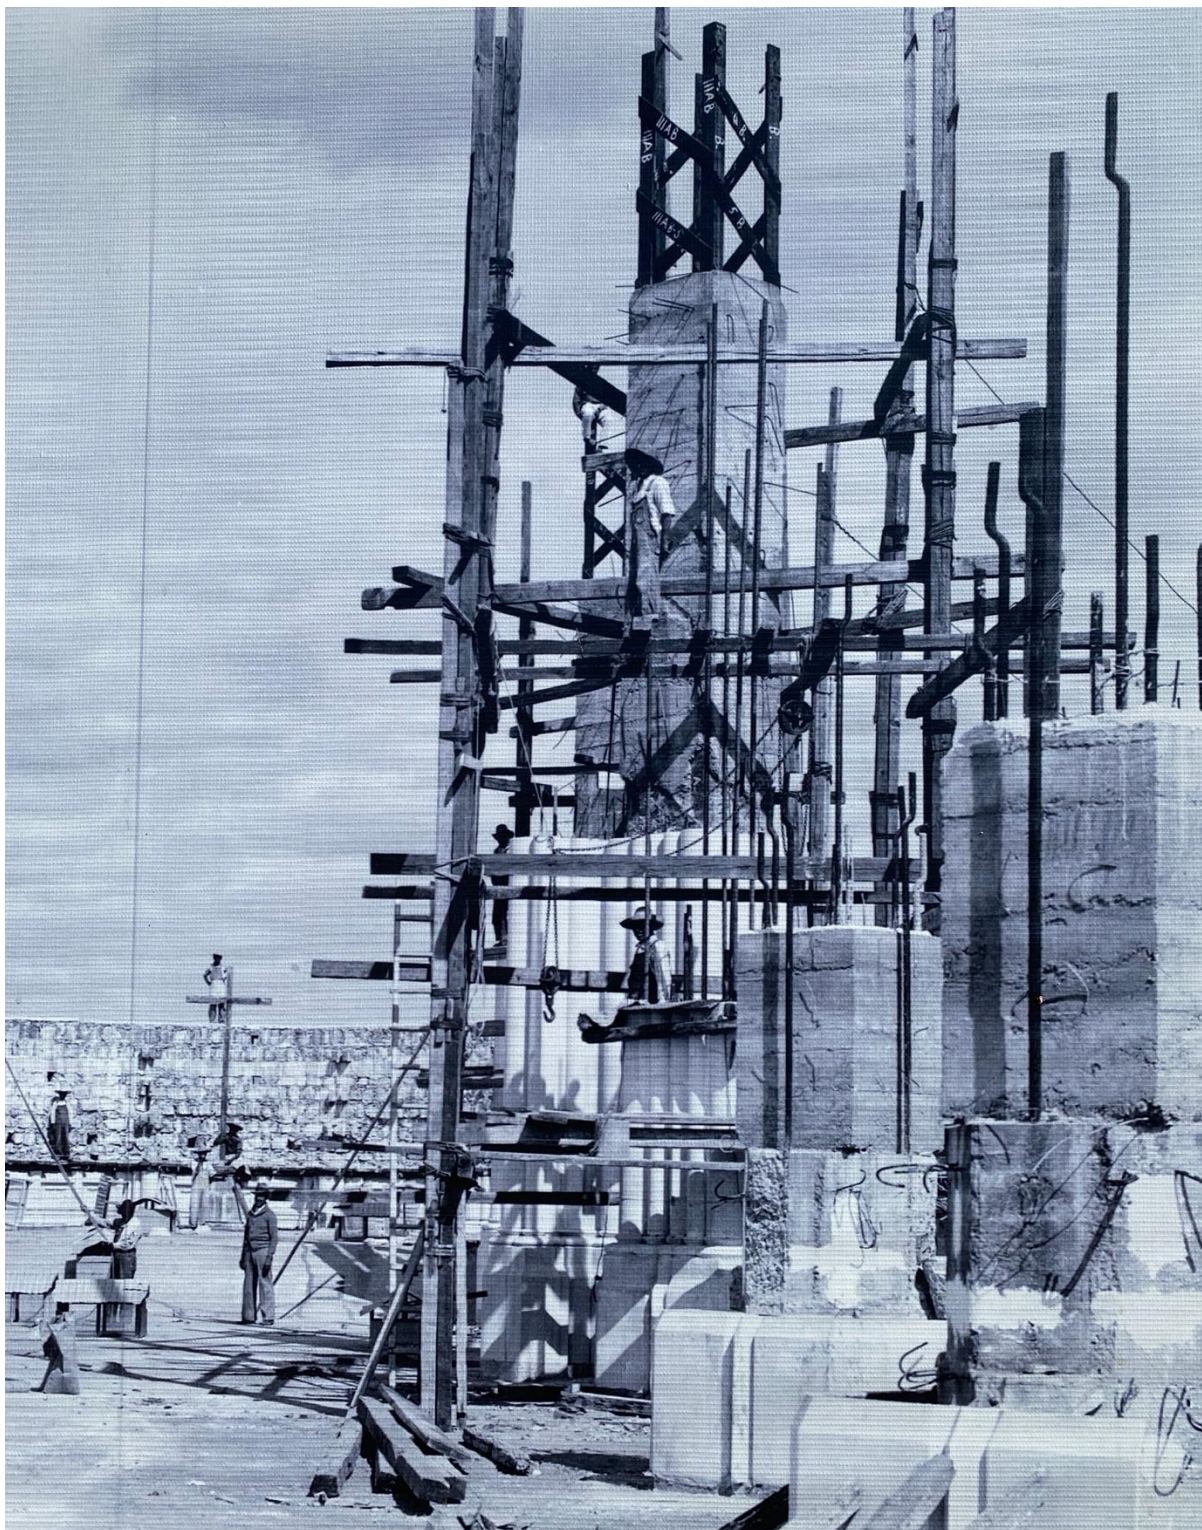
Construcción de Columnas en un sistema constructivo básico del siglo XX \_ Proceso Constructivo del T.E.D.S.C.J.
